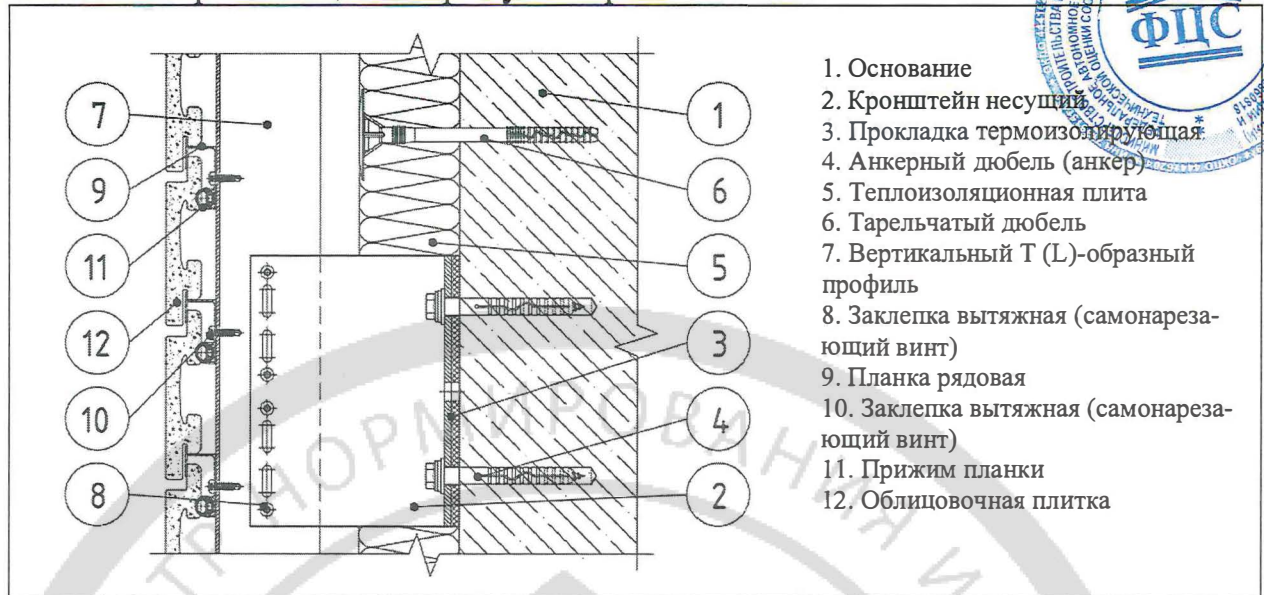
Вертикальный разрез фасадной системы “МТС-в-350” (первый вариант конструктивного исполнения несущего каркаса)
